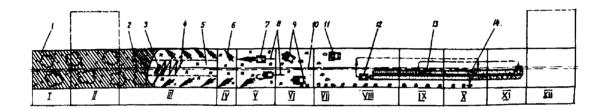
Технологическая схема расчистки строительной полосы от леса лесоповальной машиной ЛП-19 на устойчивых минеральных грунтах:
